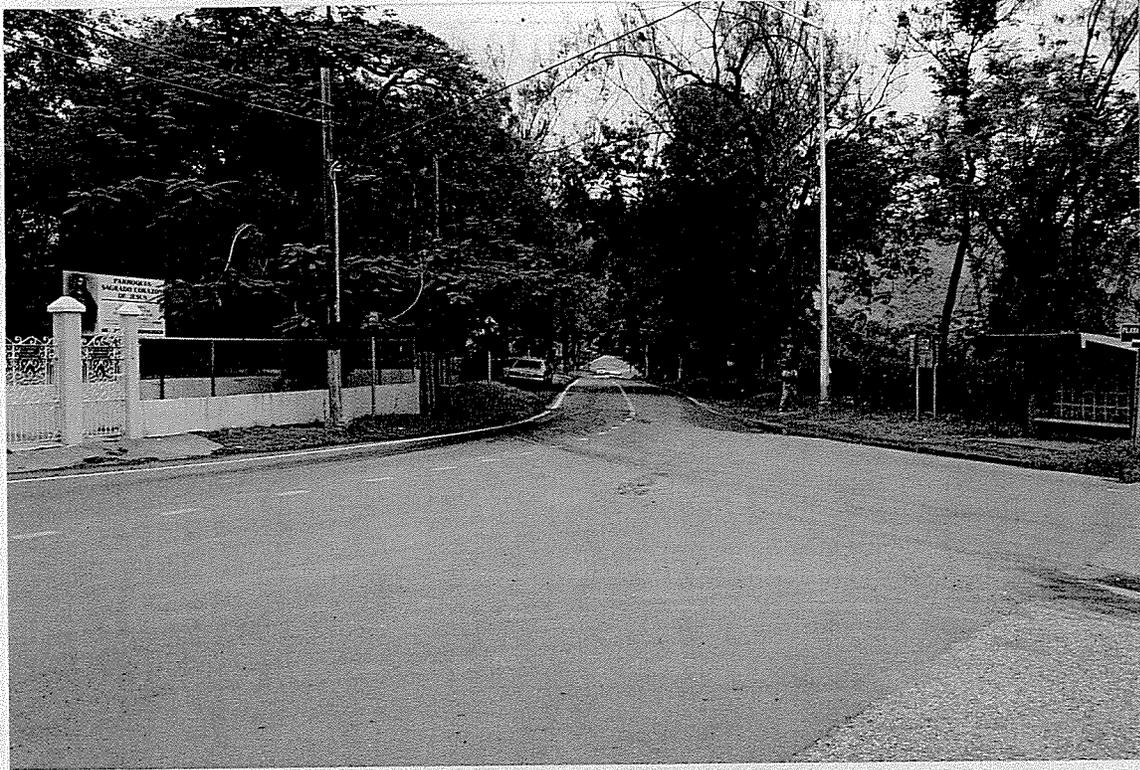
INTERSECCIÓN CARRETERAS PR-3116 Y PR-325, ACCESO NORTE
